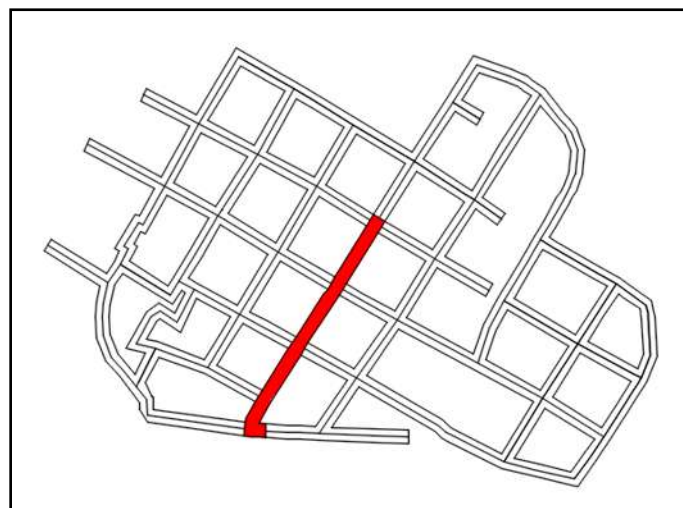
4. Calles pavimentadas con concreto hidráulico de la Población “El Platanal”
